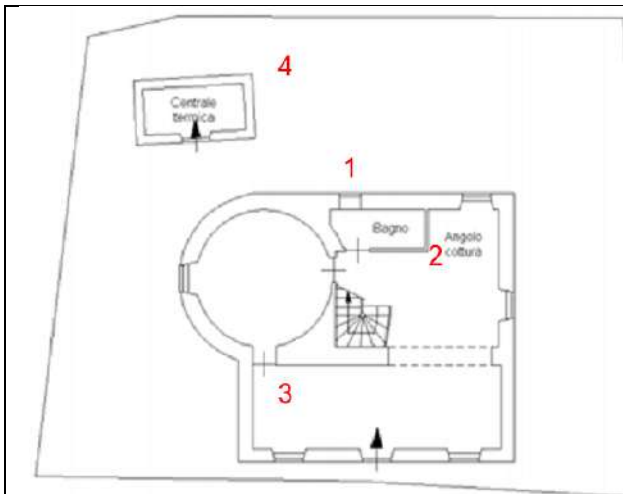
Stralcio Planimetria Catastale Fg.7 Part.662 Sub.501 - P.T. con individuazione numerica delle difformità
